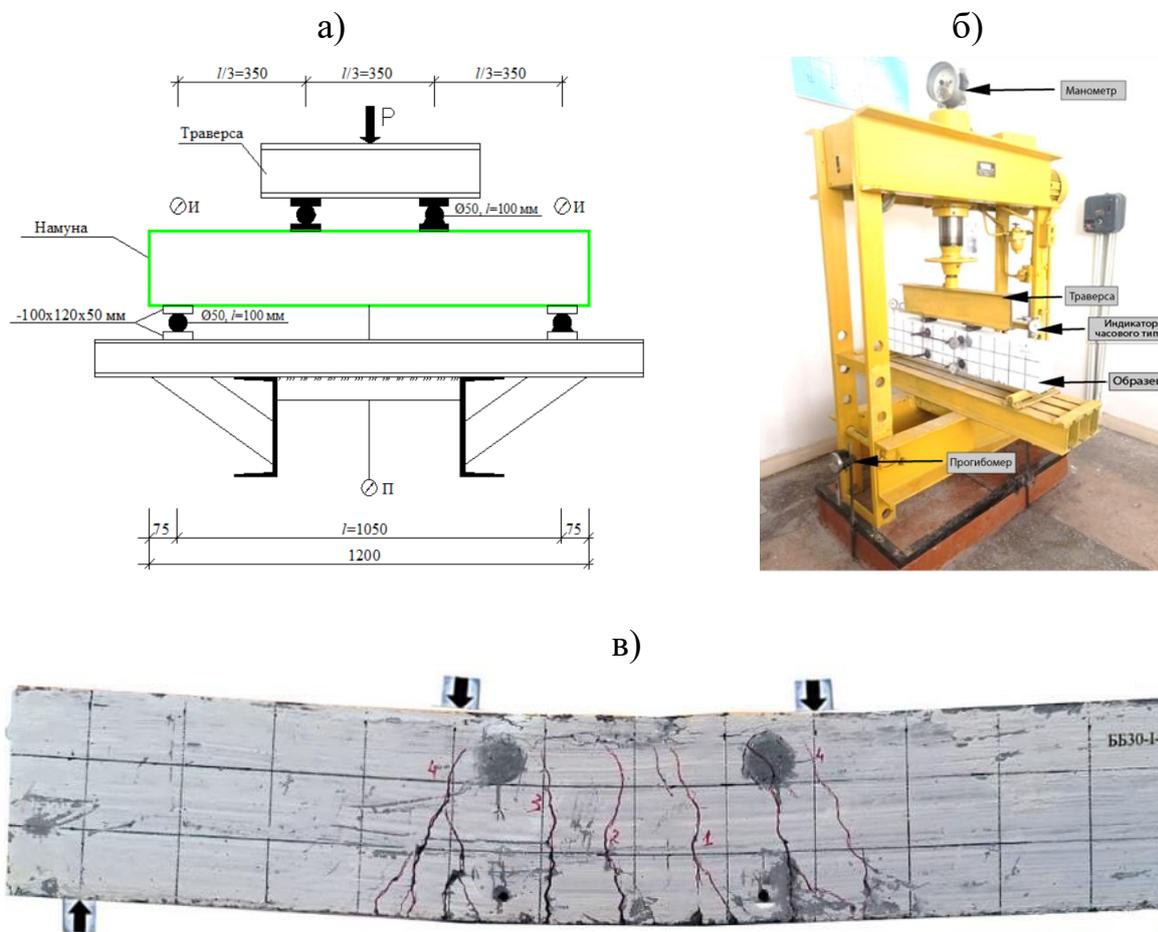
Процесс испытания фибробетонной балки: а) схема нагружения; б) процесс нагружения; в) вид фибробетонной балки после испытаний
